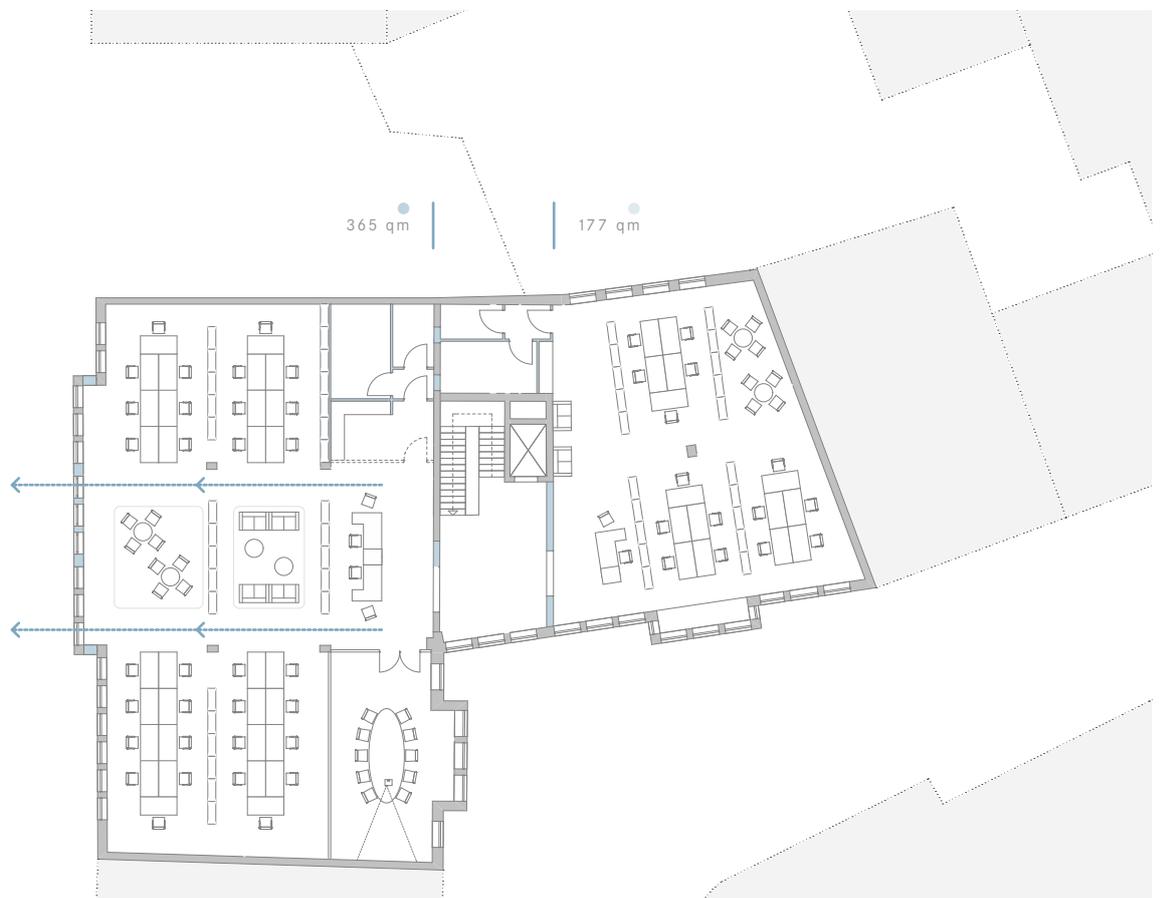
Grundriss Umbau - Grundrissaufteilung
